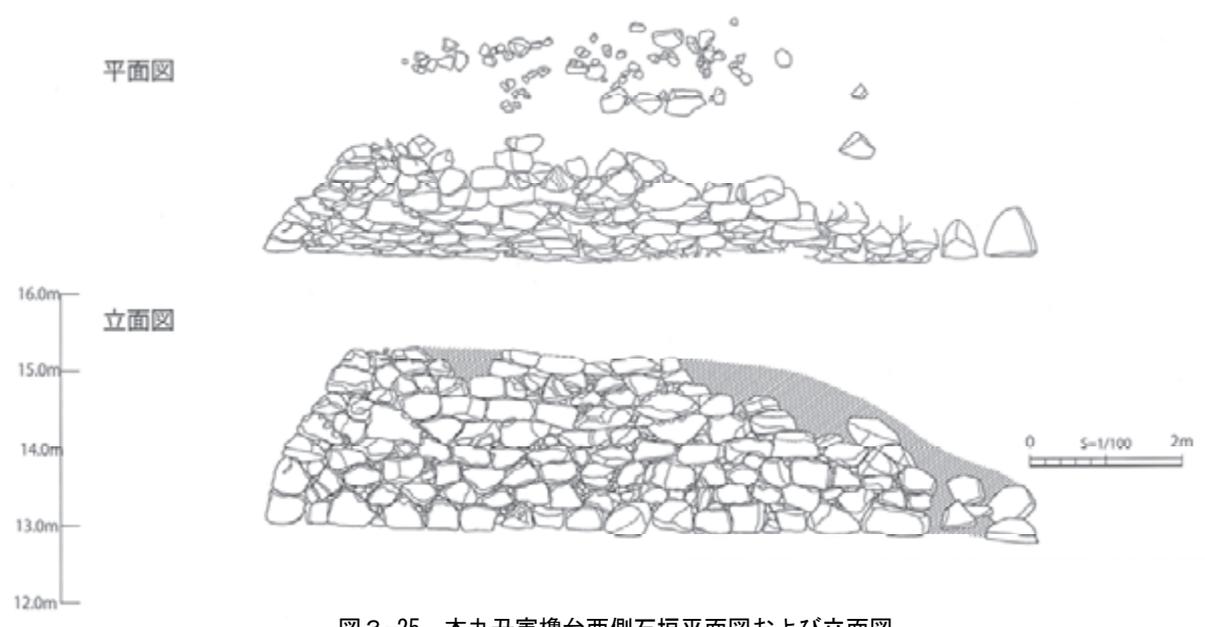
本丸丑寅櫓台西側石垣平面図および立面図
